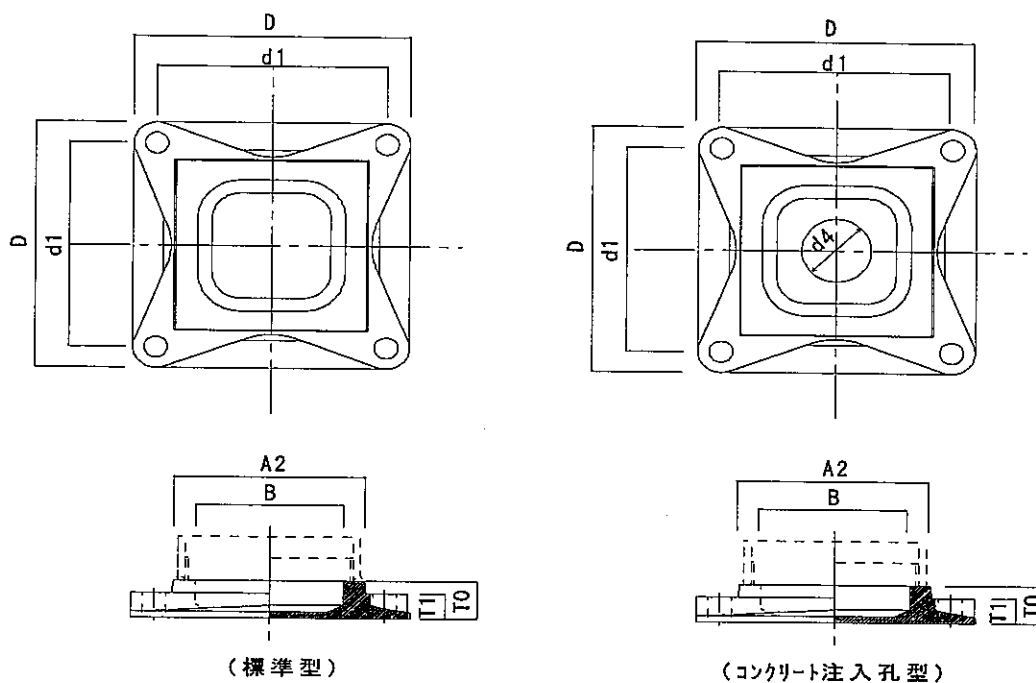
角形鋼管用ベースプレートの形状 (アンカボルト4本タイプ)
